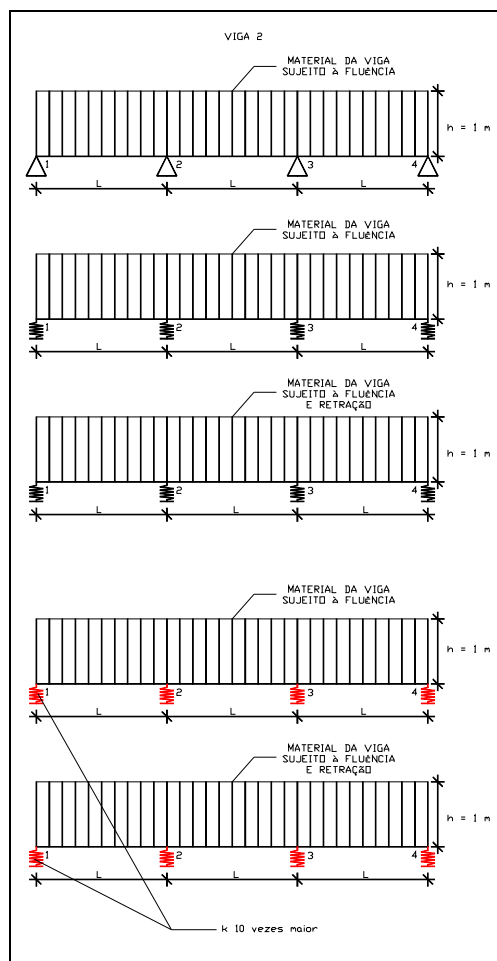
Esquemas das situações da viga 2 com quatro apoios.
